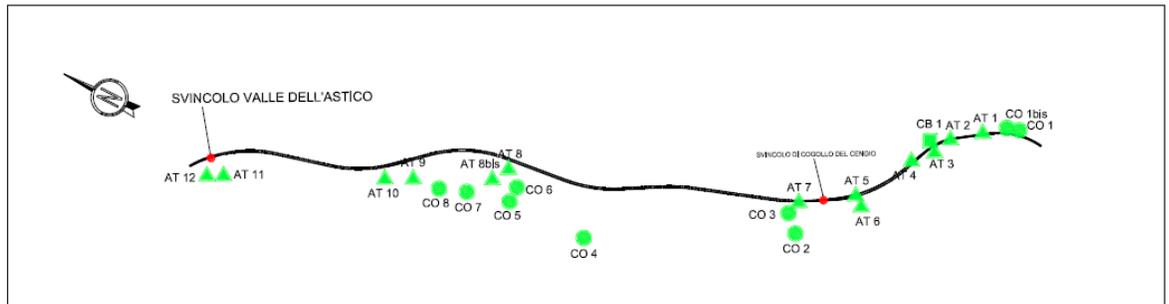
keyplan con individuazione delle aree di cantiere lungo il tracciato
